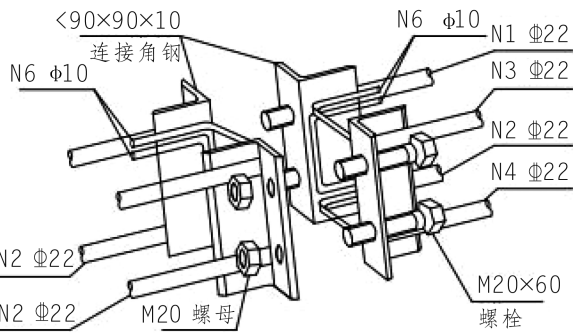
钢筋格栅拱架连接轴测示意图(单位:mm)
